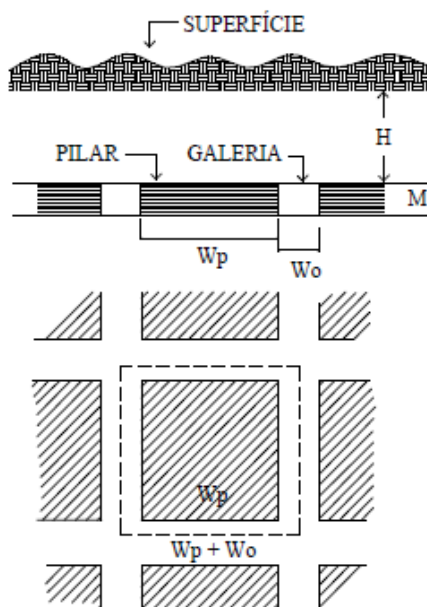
Representação da área tributária de carregamento de cada pilar e espessura da cobertura.
